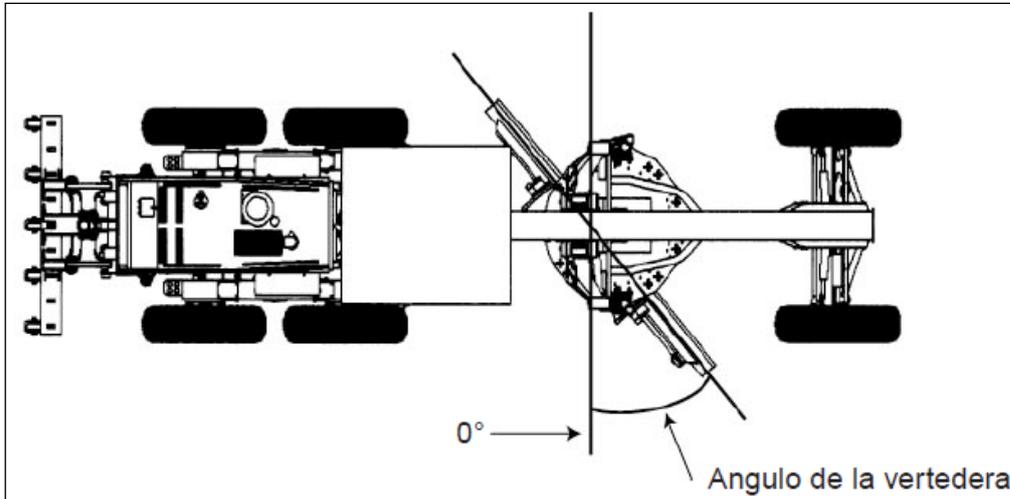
Posicion angular de la cuchilla de la motoniveladora
